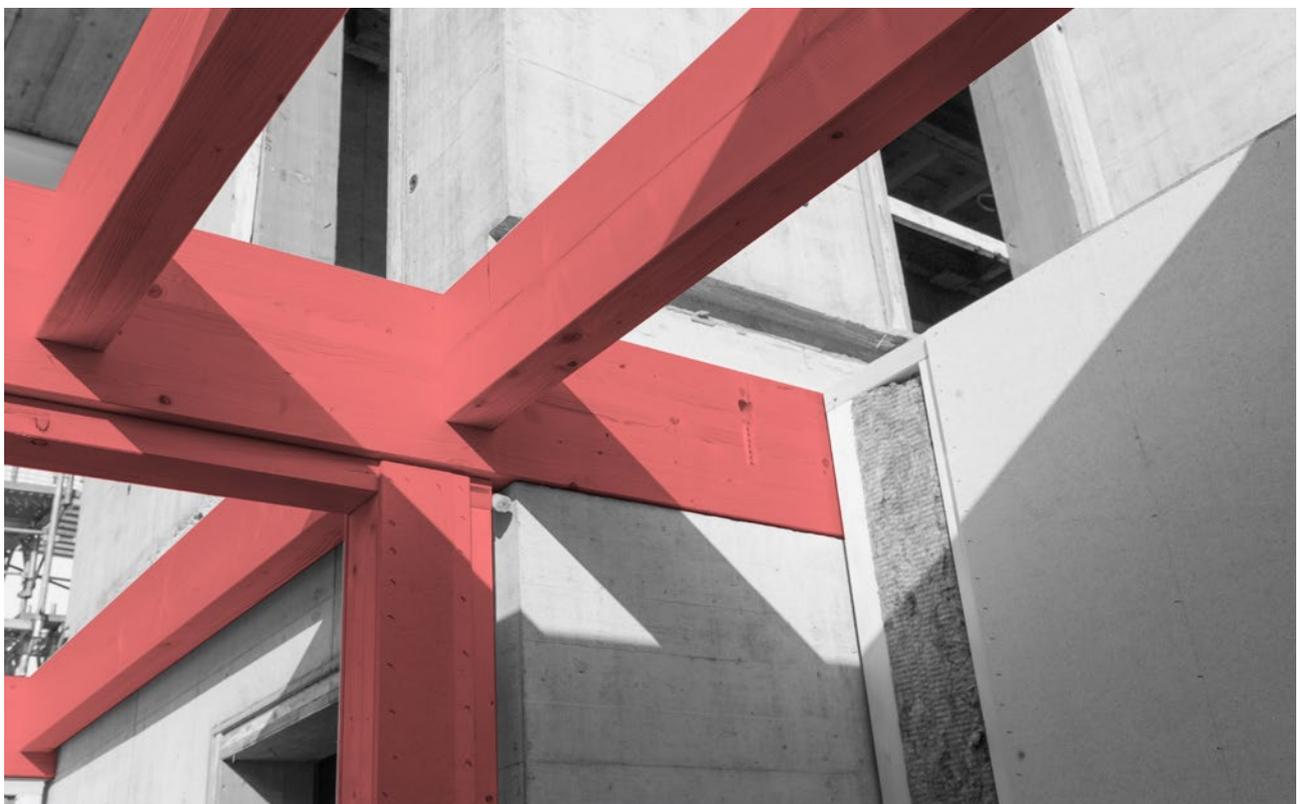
Baustellenfoto von der Verzahnung des Betonkerns und der Holzkonstruktion
